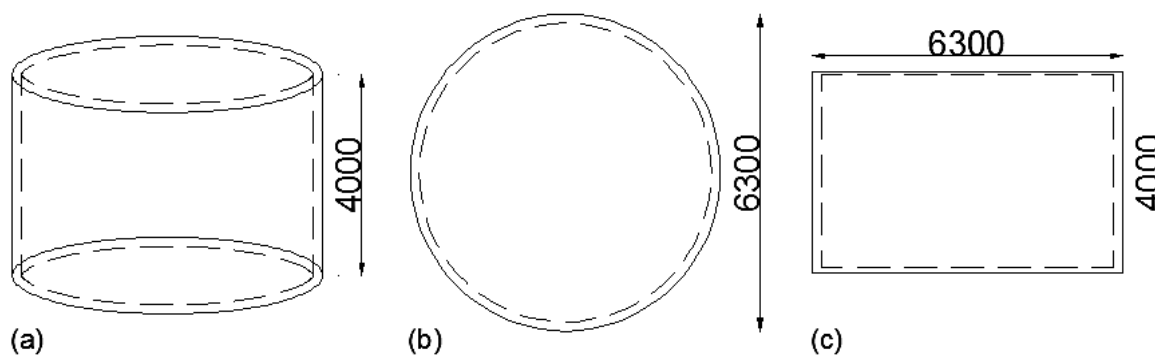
Detalhe do reservatório. (a) Perspectiva (b) Planta baixa (c) Elevação, em mm.
